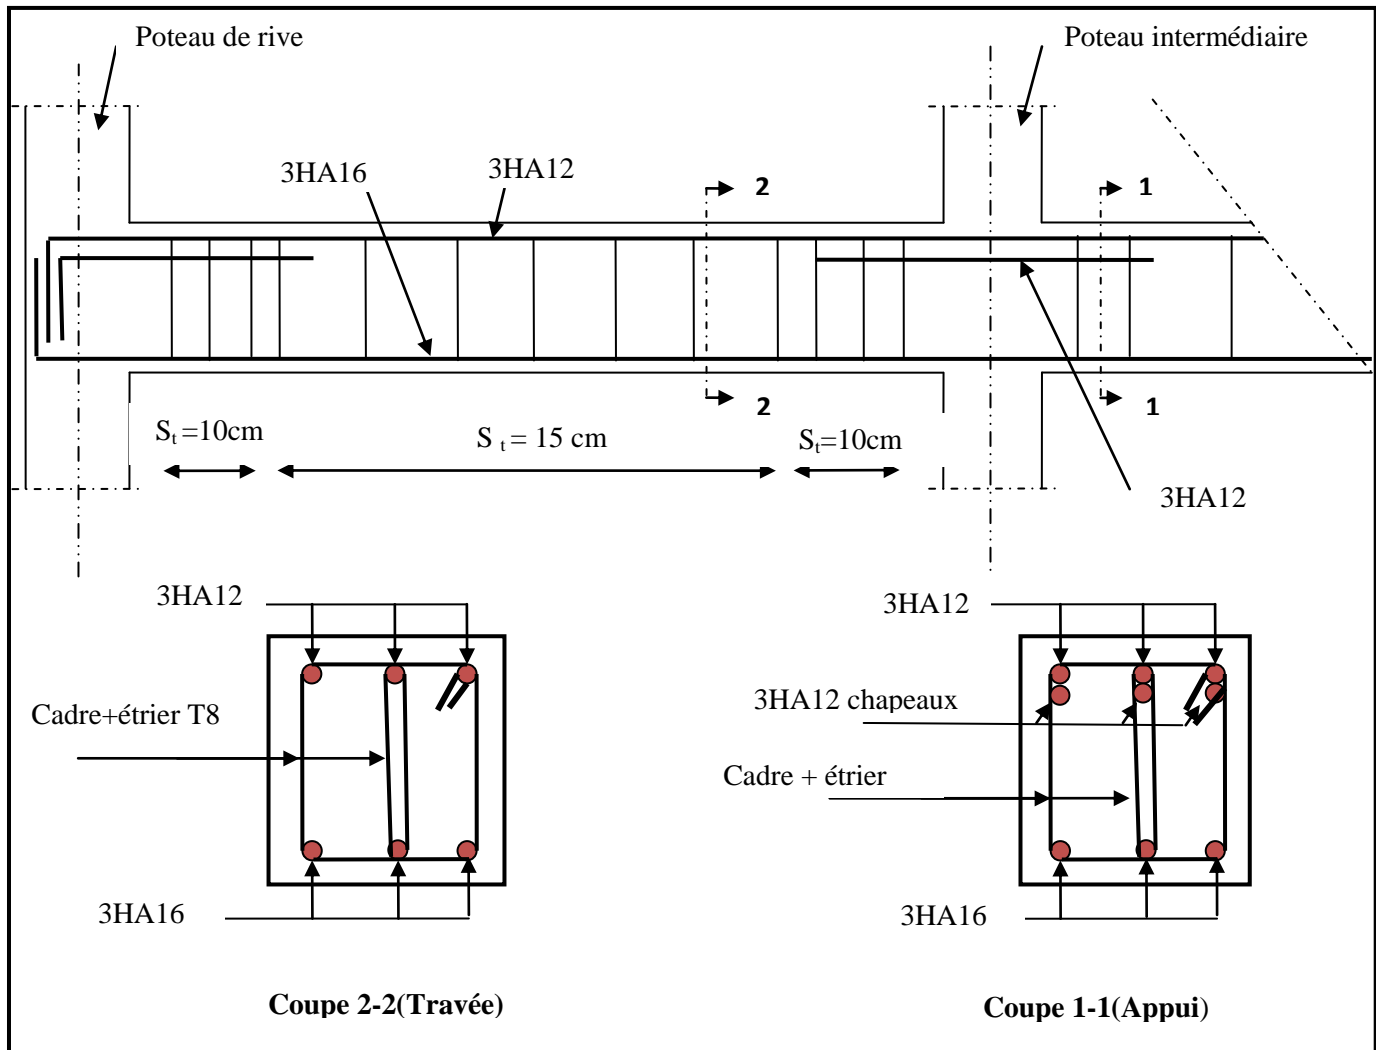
Ferrailage des poutres principales et secondaires d'étage commercial et terrasse et des poutres secondaires d'habitation.
